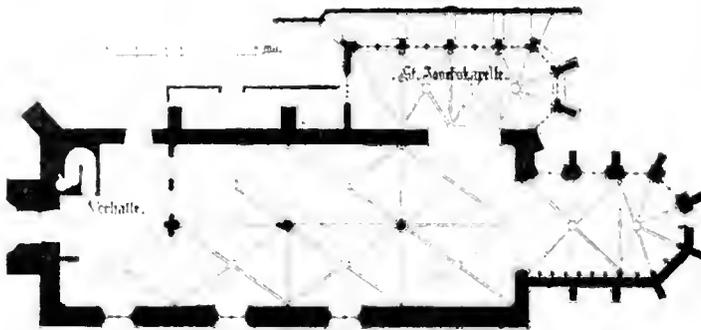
Imbach, Pfarrkirche, Grundriß 1:500
